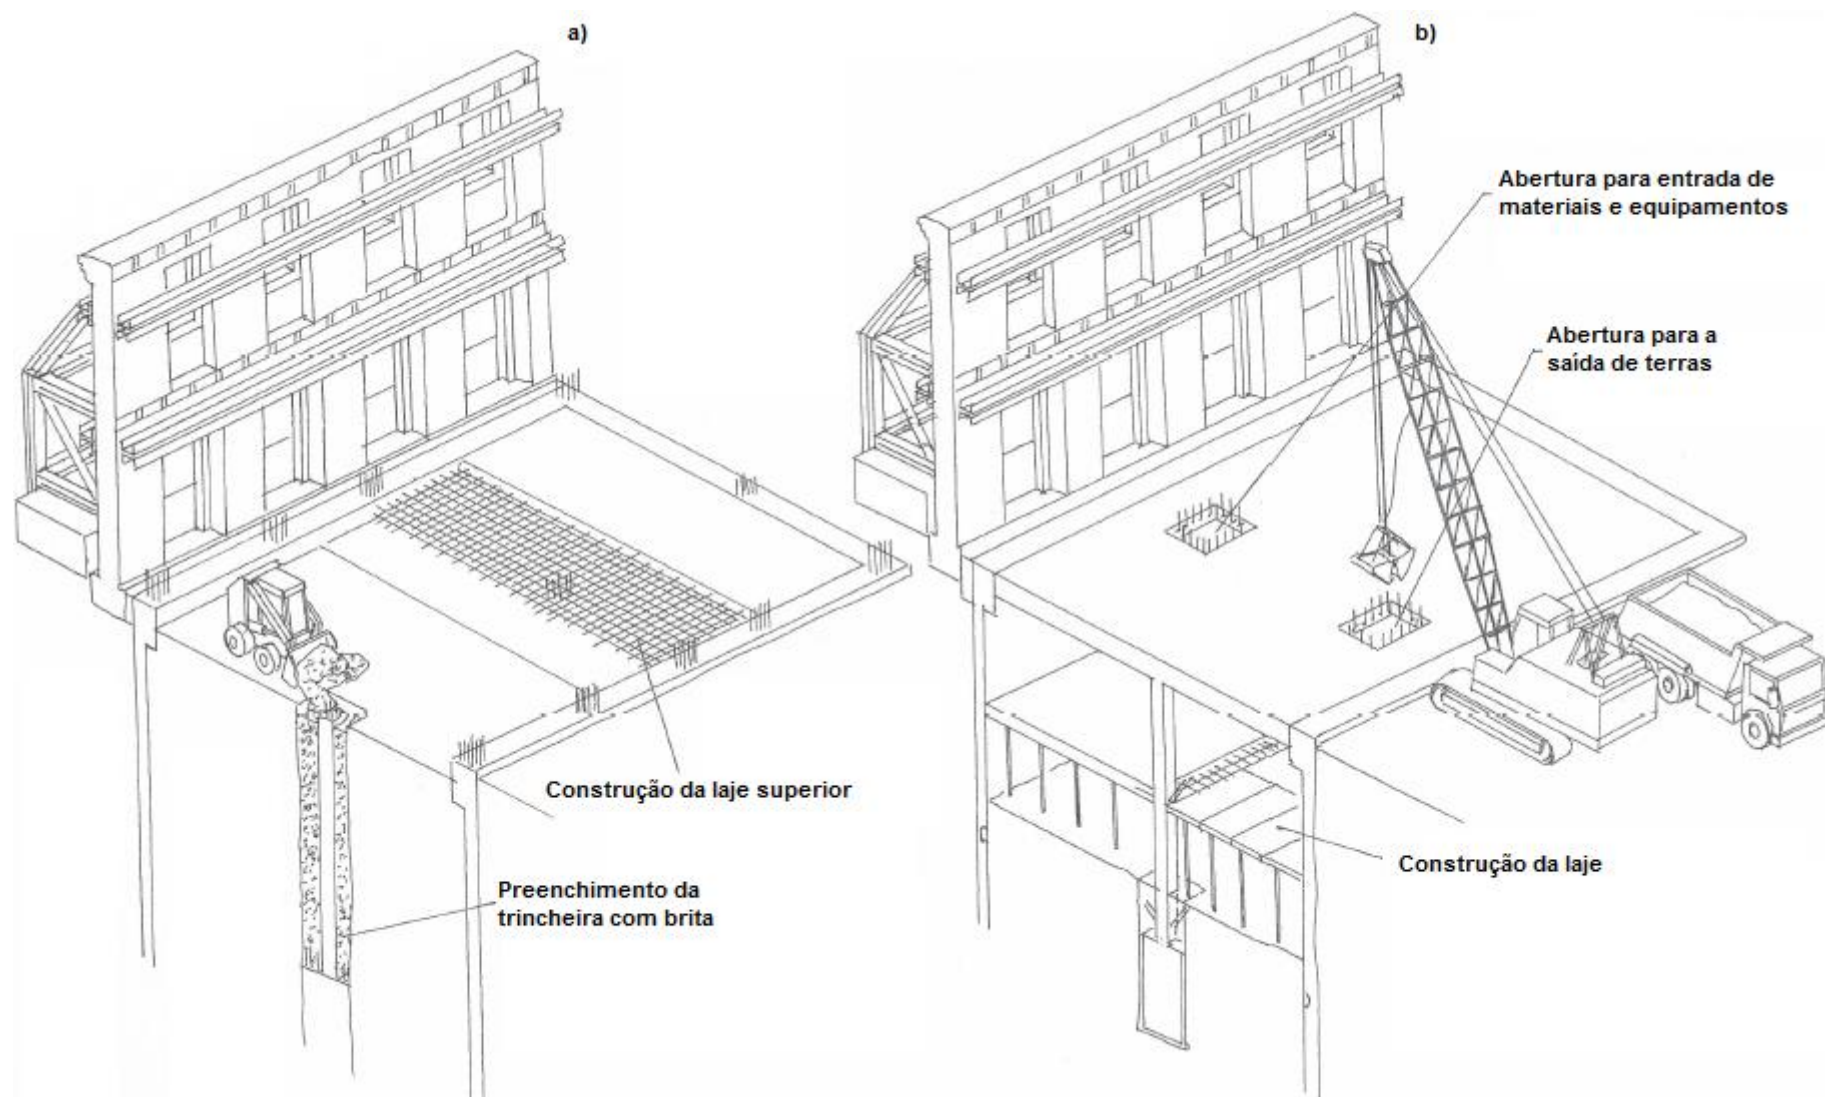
Construção de cave: a) construção da laje superior; b) escavação por níveis e construção da laje de cada um dos níveis [55]
